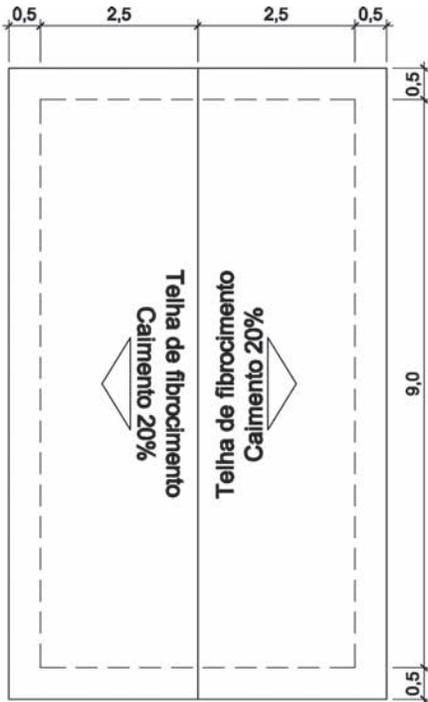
Croqui da planta de cobertura da habitação padrão de interesse social
